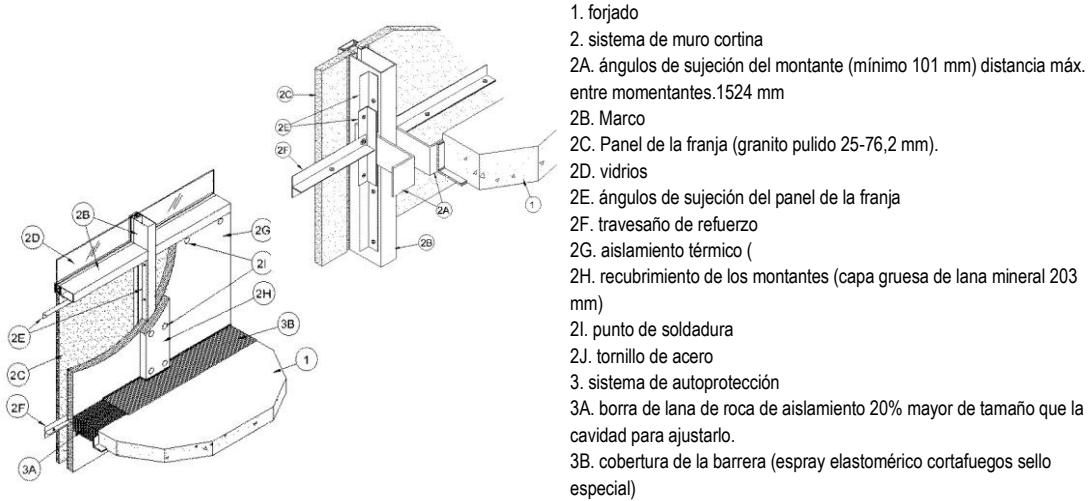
Detalle constructivo exigido para muros cortina. XHDG.CW-S-2057. Certificado por UL *Underwriters Laboratories Inc.* Ensayado según la norma: ANSI / UL 2079
